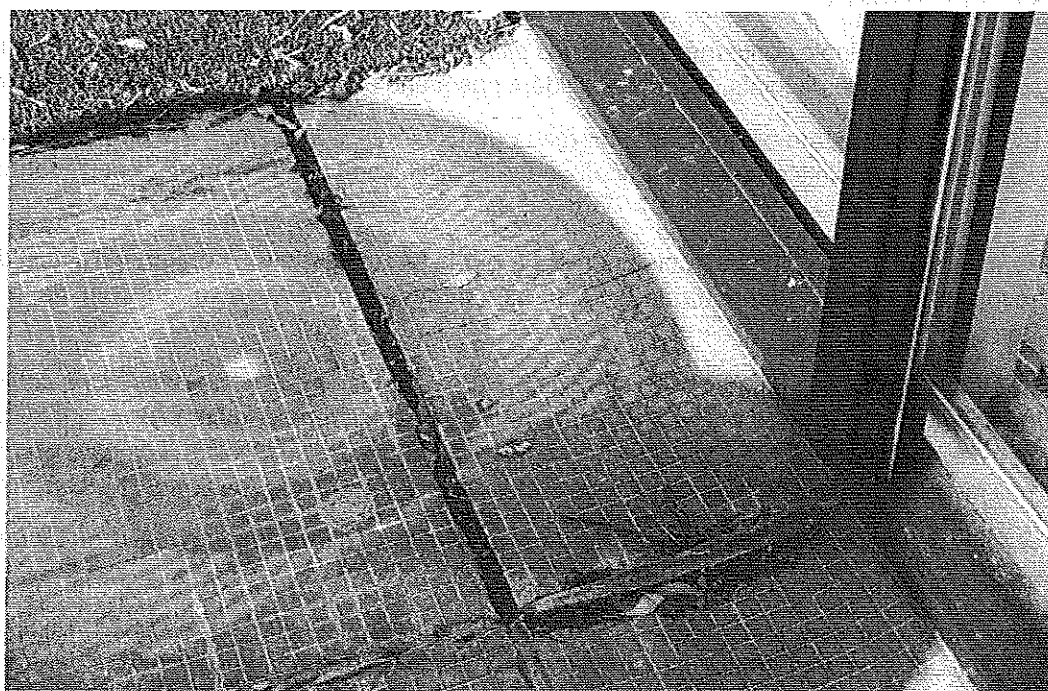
Dégradation d'un joint de fractionnement du carrelage (terrasse 7^e étage). © J. Putatti
